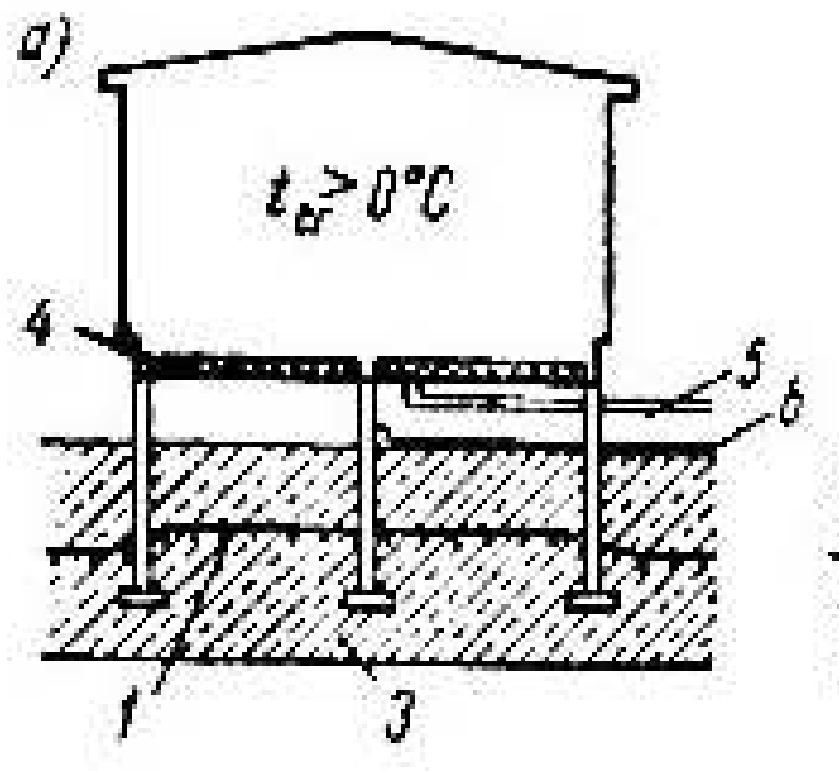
Схема устройства вентилируемого подполья. 1 - верхняя граница вечномерзлых грунтов; 2 - насыпной или замененный грунт; 3 - просадочный грунт; 4 - термоизоляция; 5 - трубопровод; 6 - лоток под трубопроводом для отвода аварийной воды;
